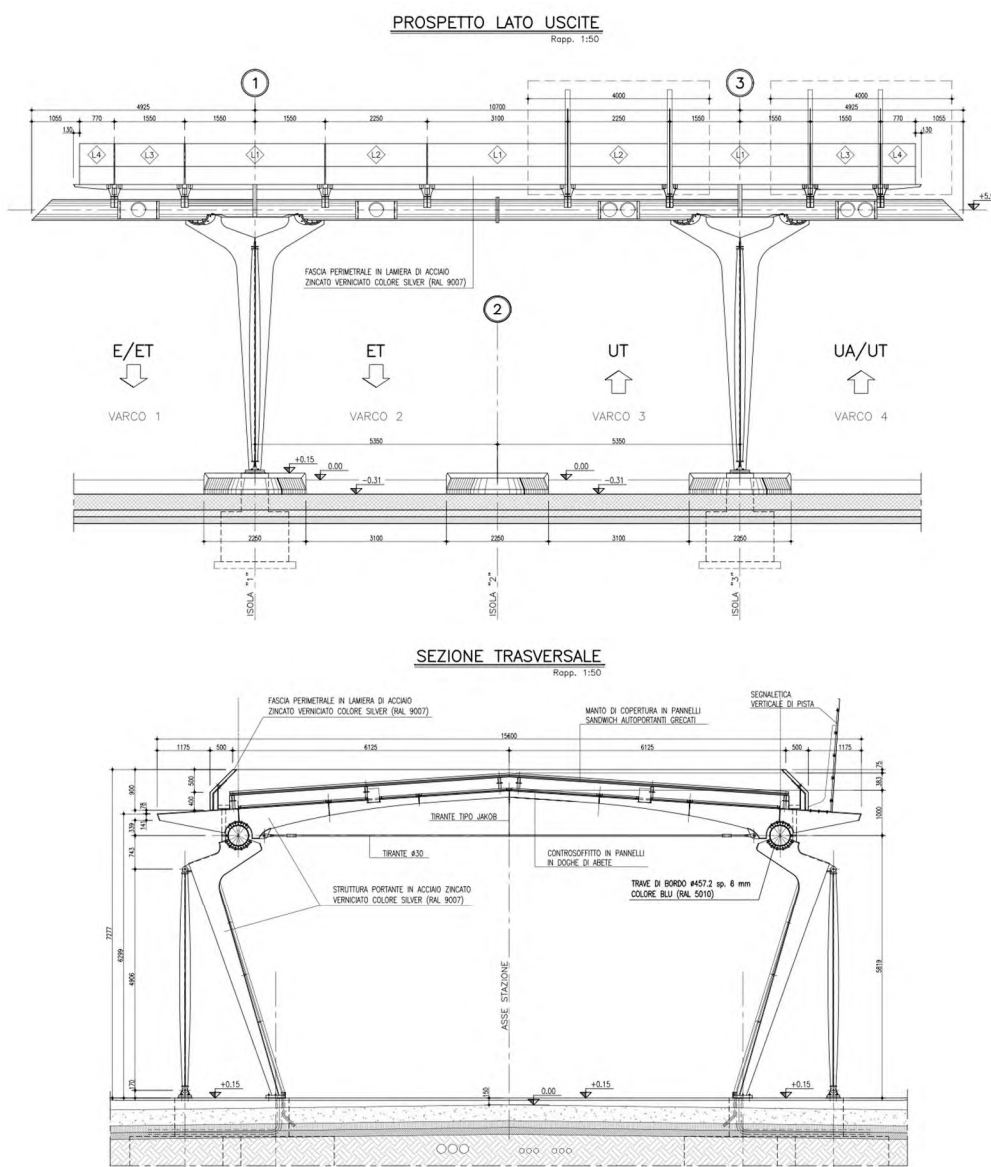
Pensilina di stazione – Prospetto e sezione
